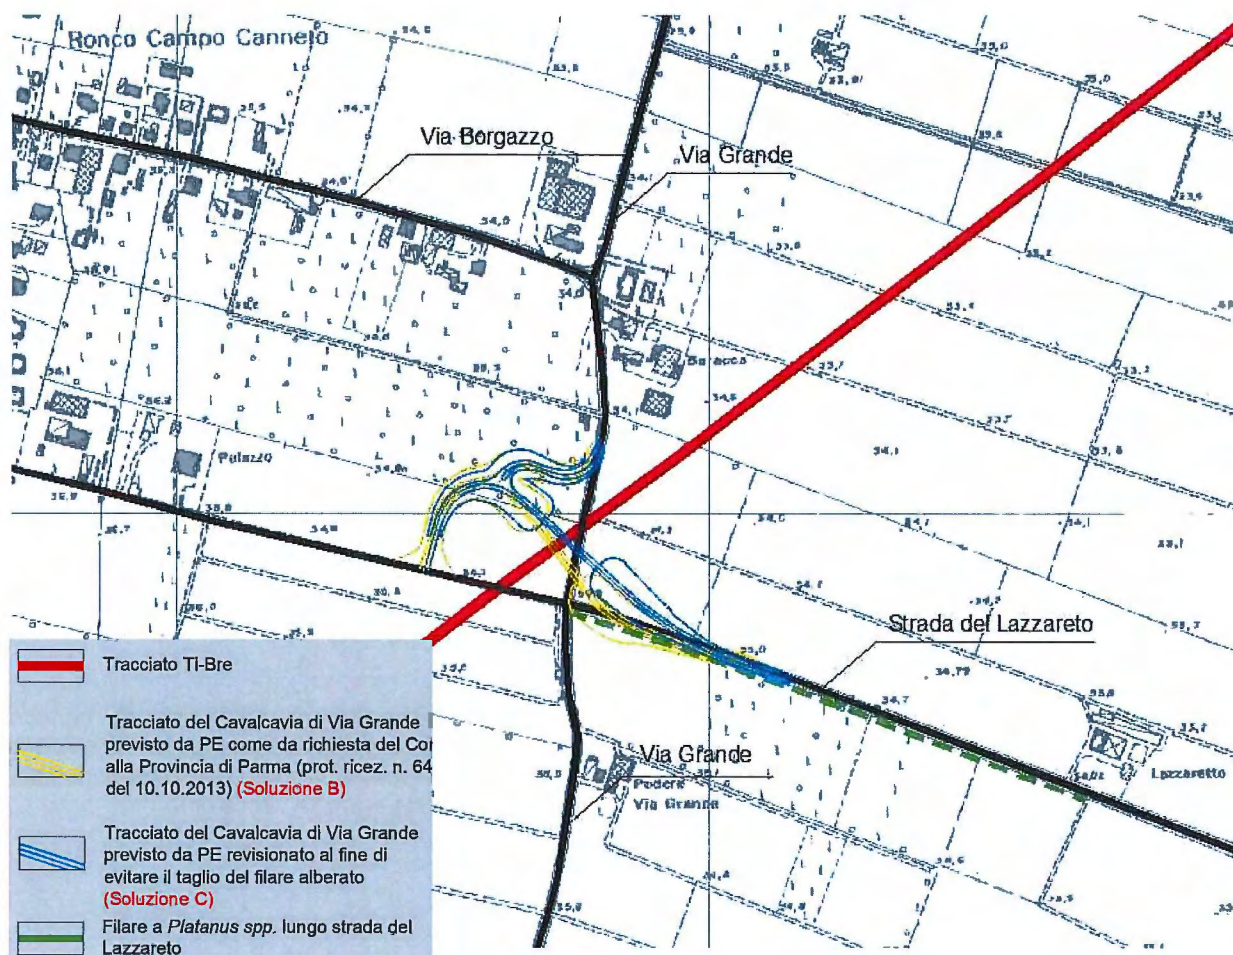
Rappresentazione schematica dell'ubicazione del Cavalcavia di Via Grande come prevista dal Progetto Esecutivo (soluzione B in giallo) e alternativa (soluzione C in azzurro) che permette di salvaguardare il filare alberato.
